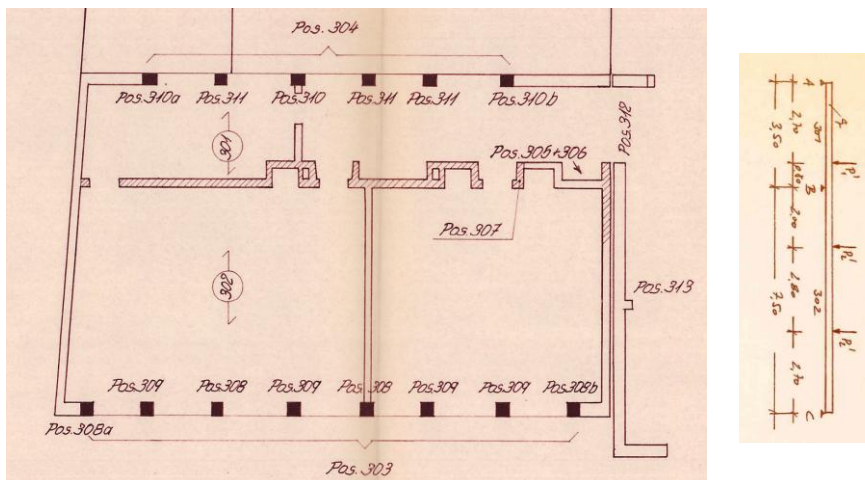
Auszug aus Positionsplan und statisches System Decke über 2.OG [1]
